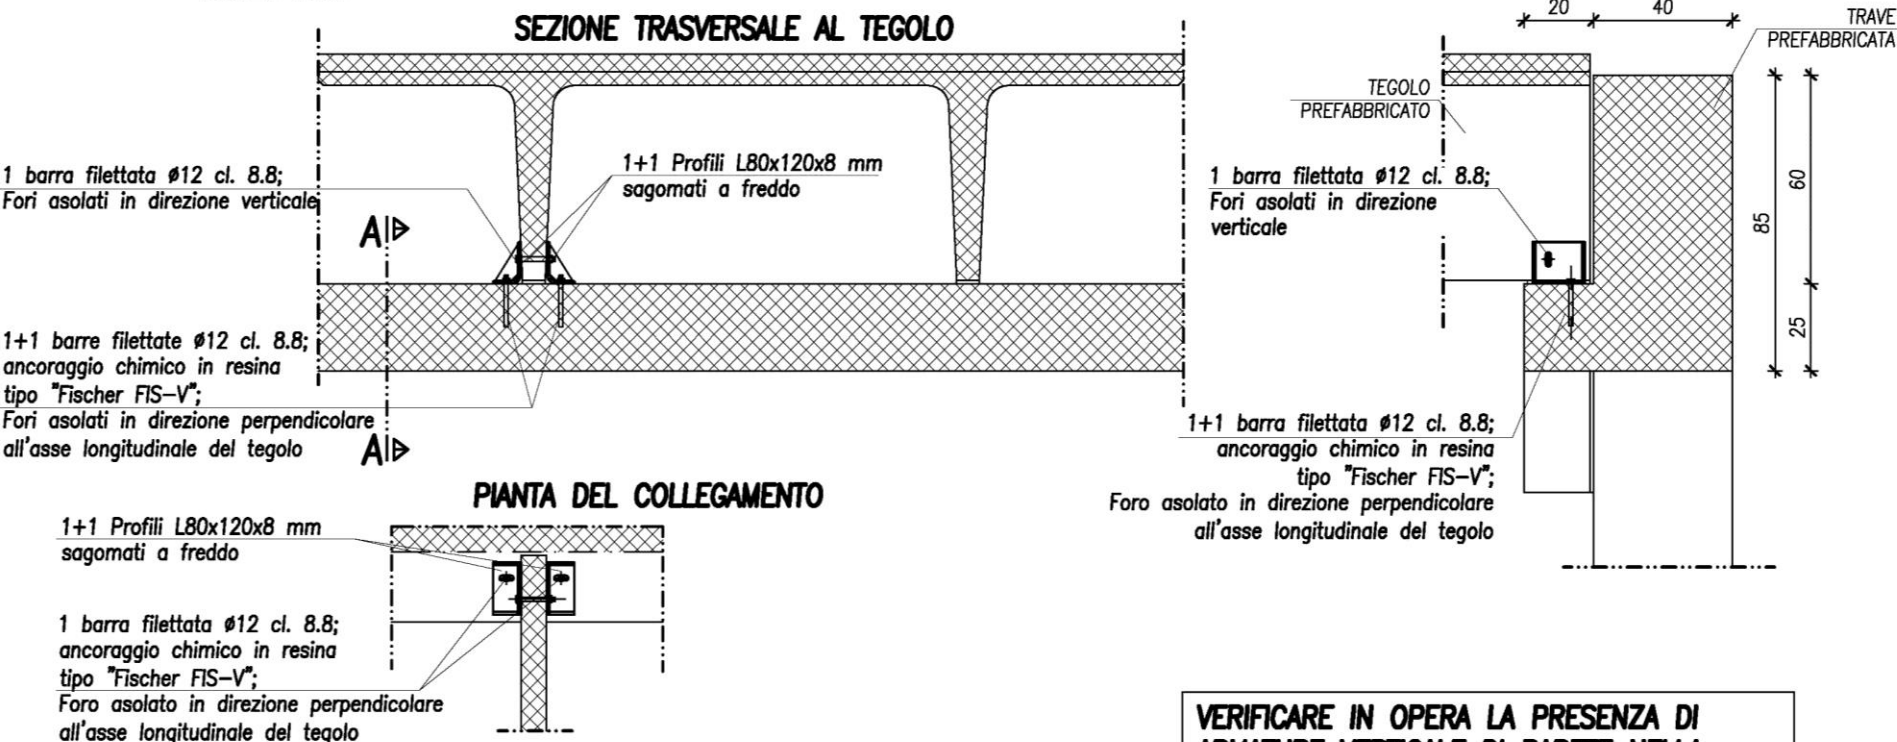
dispositivo di collegamento del tegolo alare Ondal alla trave TR
